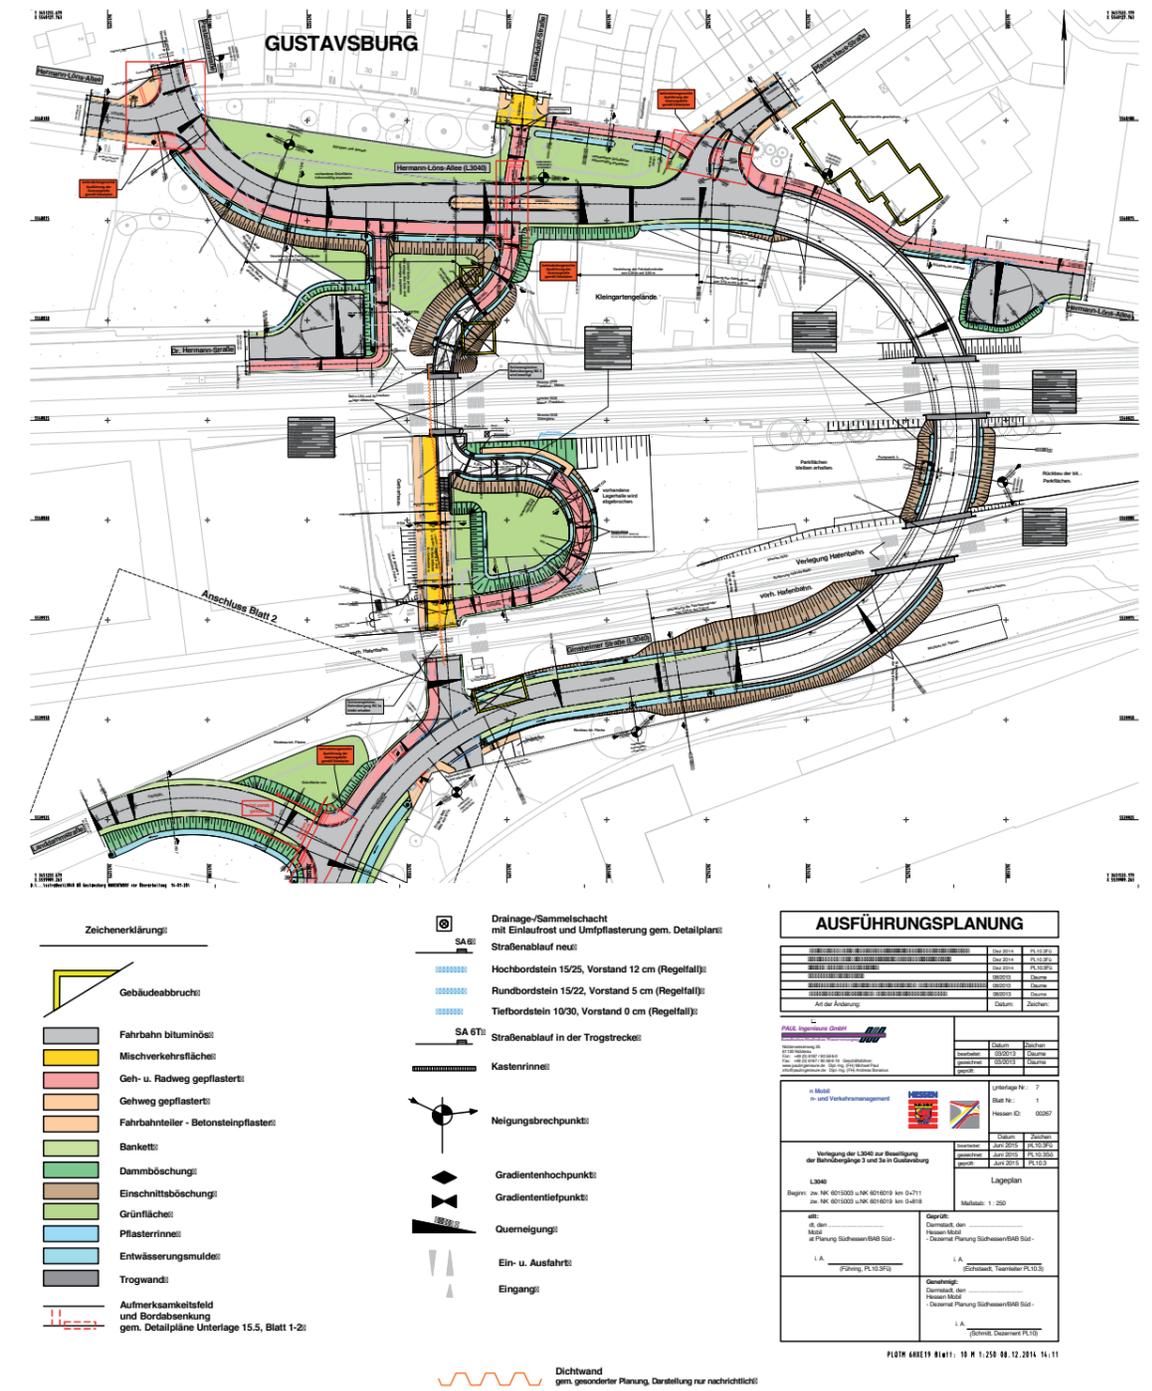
Lageplan der geplanten Unterführung L3040 (Quelle: Stadt Ginsheim-Gustavsburg 2020)
